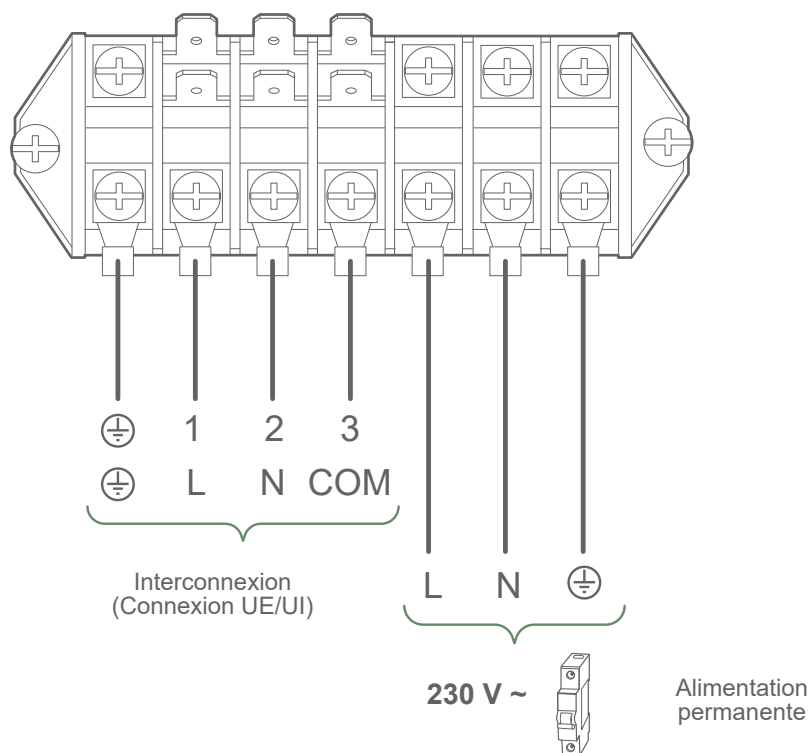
Passage des câbles et installation des bagues à 1 contact
